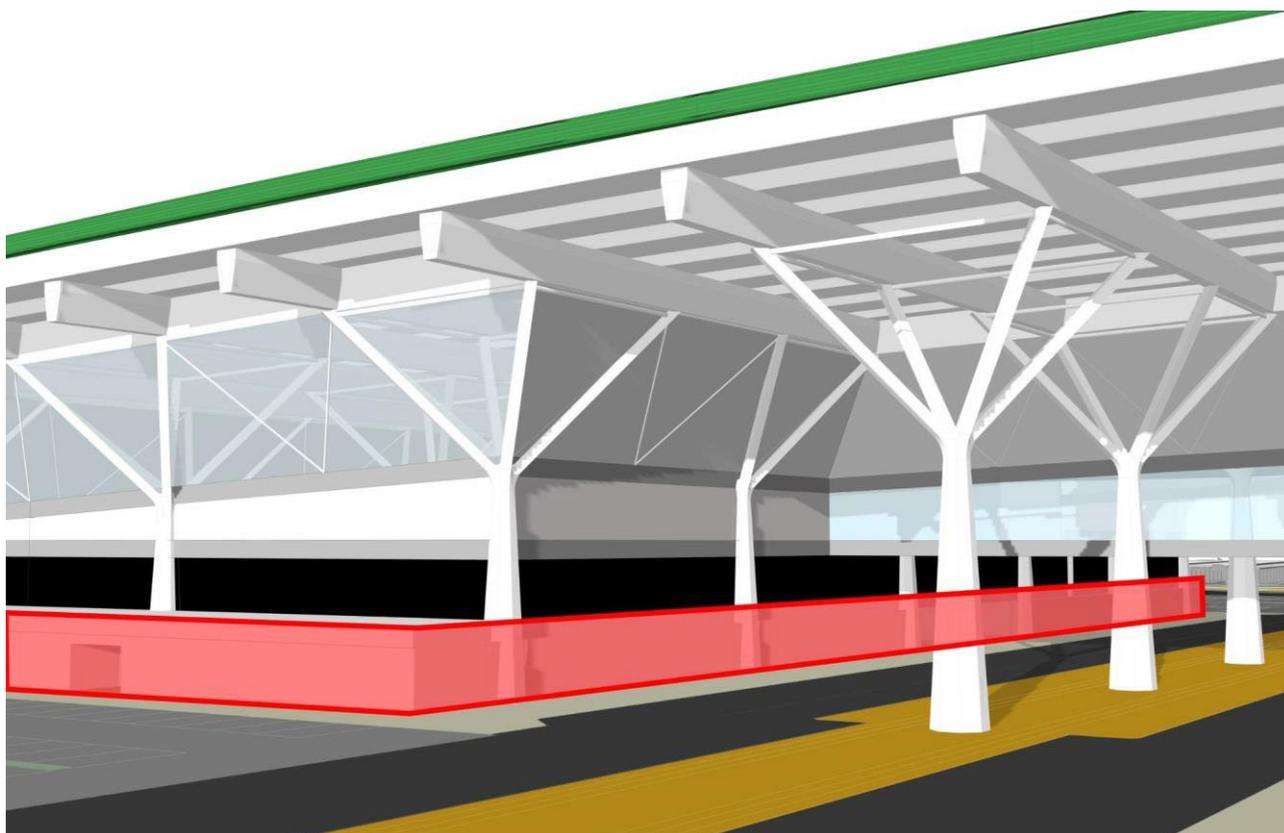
EWS-202: Facciata in calcestruzzo prefabbricato. Mark up di facciata.
